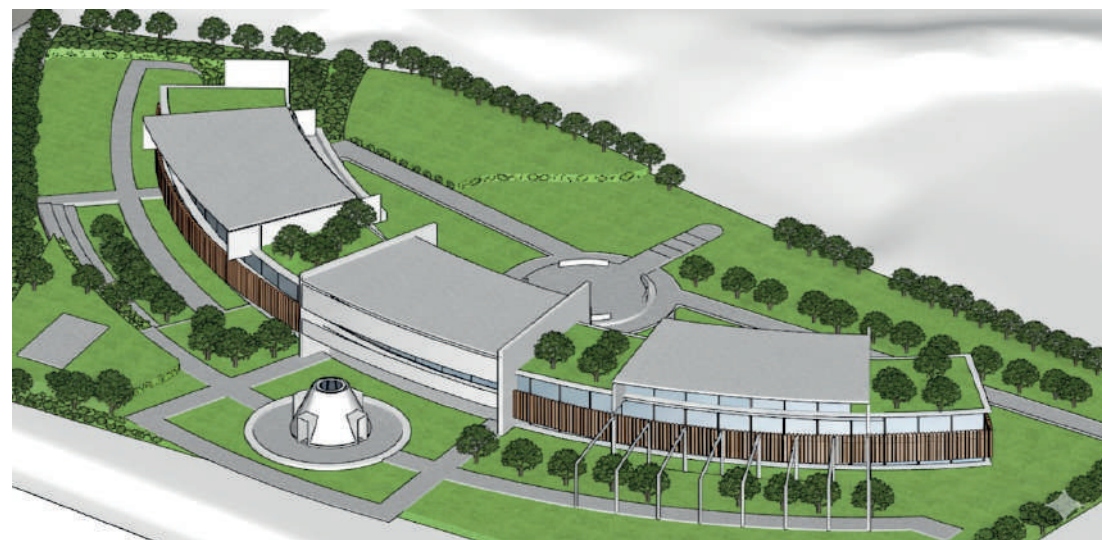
Ficha #3 certipiloto. Fuente: Elaboración propia. 2025
